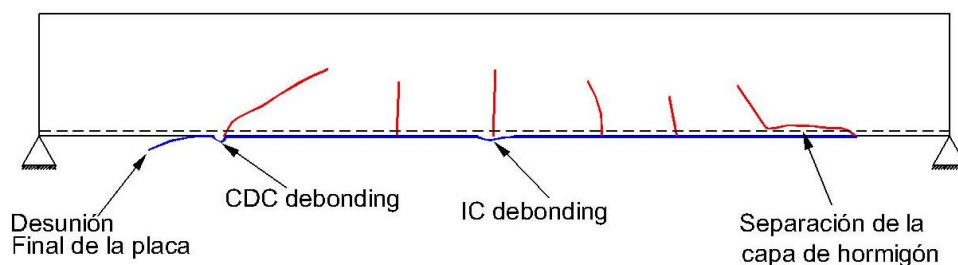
Modos de fallo de desunión en vigas de hormigón reforzadas a flexión con FRP.
